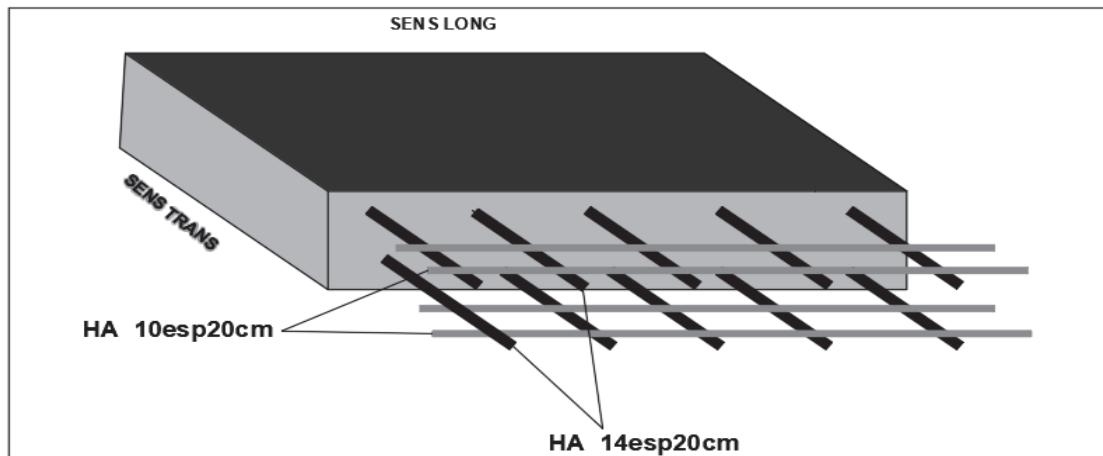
Ferrailage de l'hourdis (les deux nappes)
